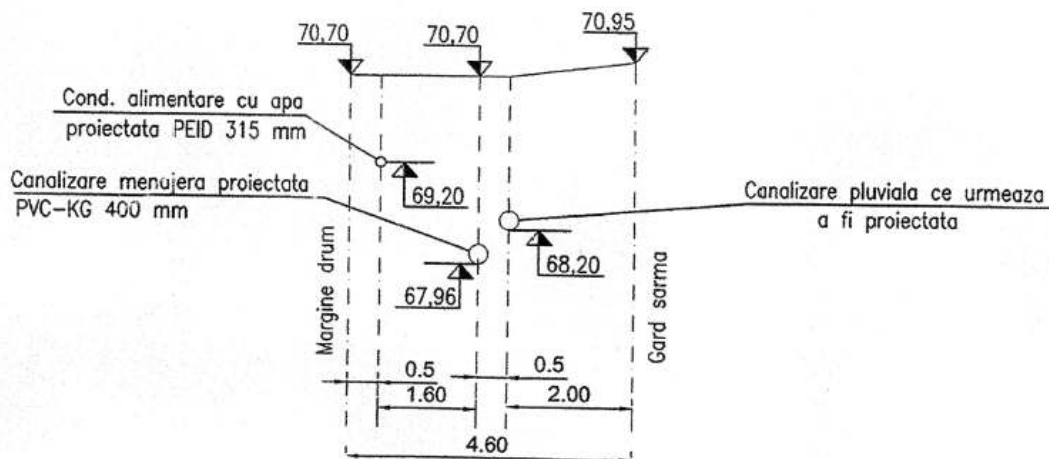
Secțiune transversală extrasă din proiectul tehnic de execuție
